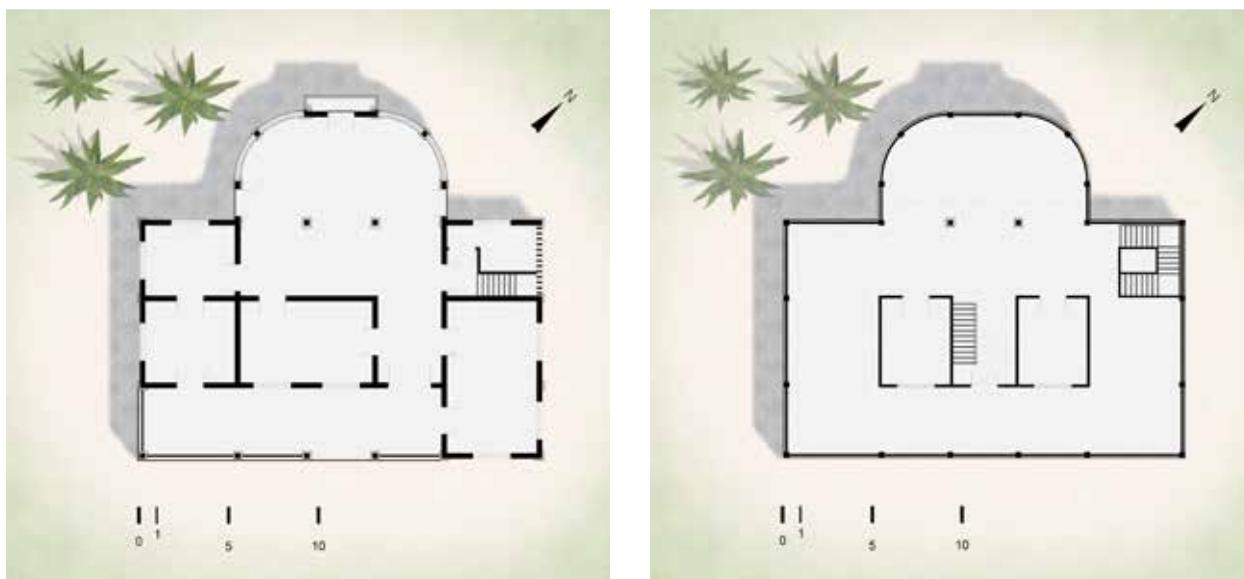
| Reconstrucción hipotética de la planta de la casa de 1927. Ilustración: D. García.
